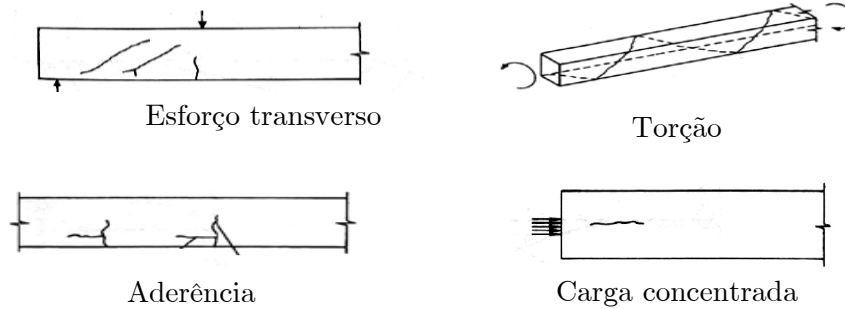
Fissuração devido a atuação das cargas [7]
